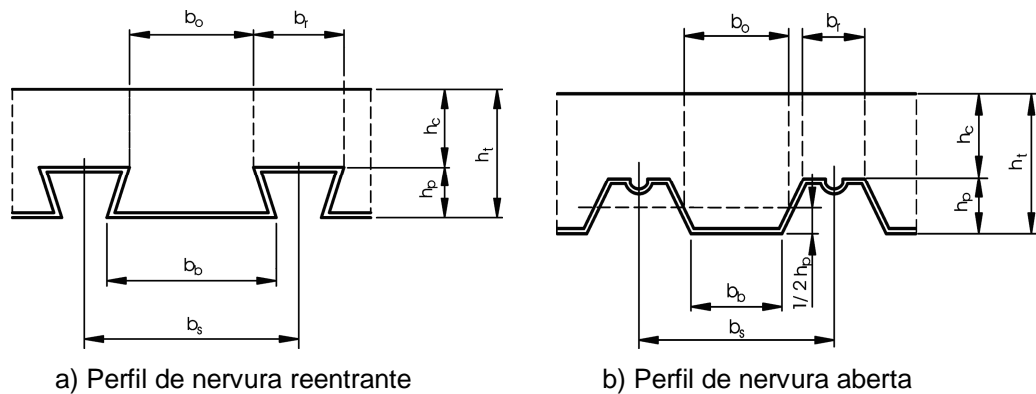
Parâmetros geométricos das chapas e das lajes
